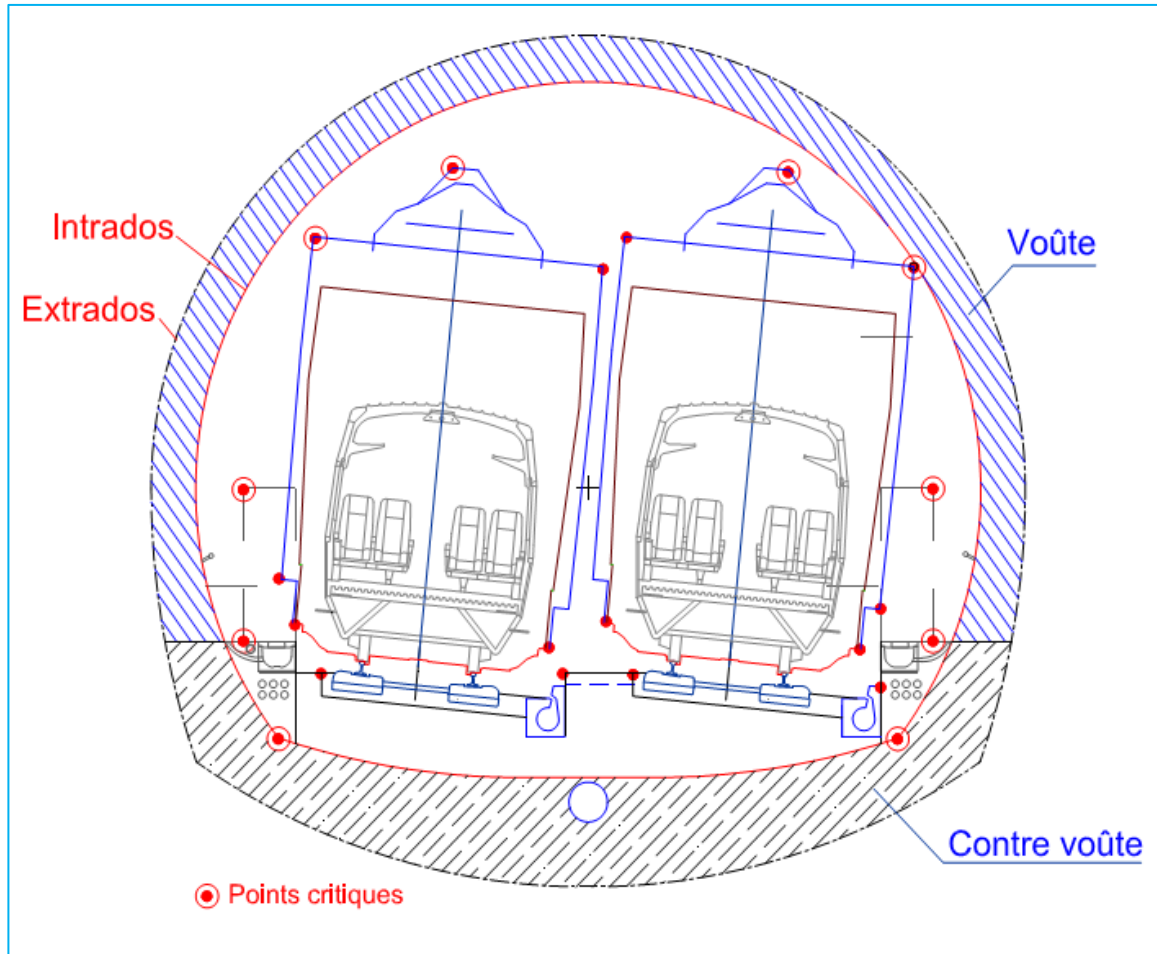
Coupe type de revêtement définitif d'un tunnel avec radier contrevouté.
